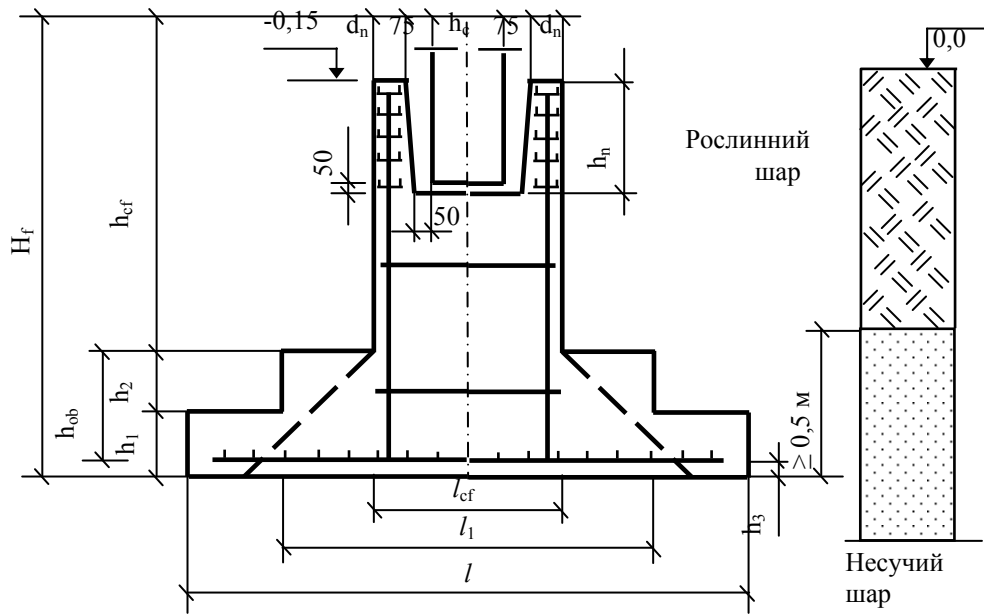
Конструкція фундаменту під збірну колону з підколонником
